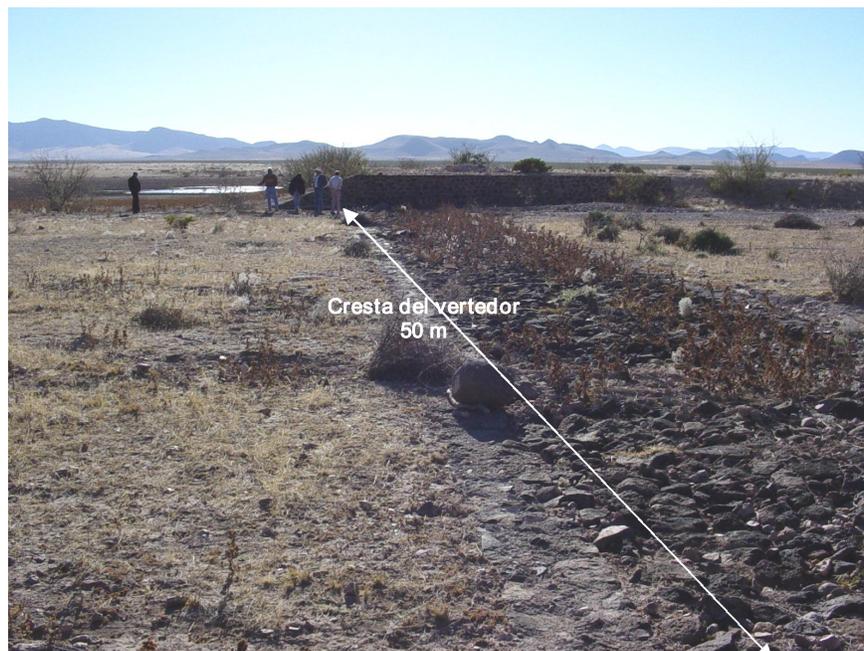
Vista de la cresta del vertedor de la represa Los Charcos
